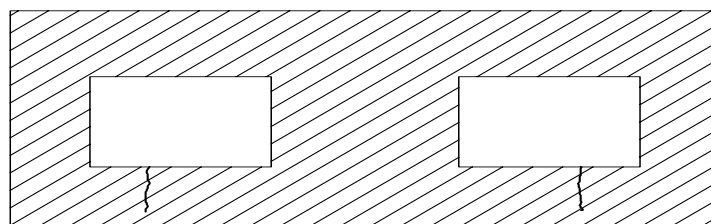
Fissuration longitudinale d'arcs en caisson
